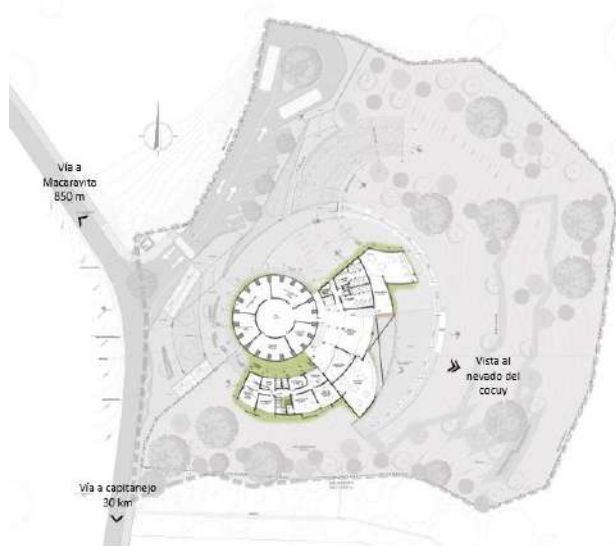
Planta nivel -3.5m edificio Sur, administración, cuarto máquinas y salones
